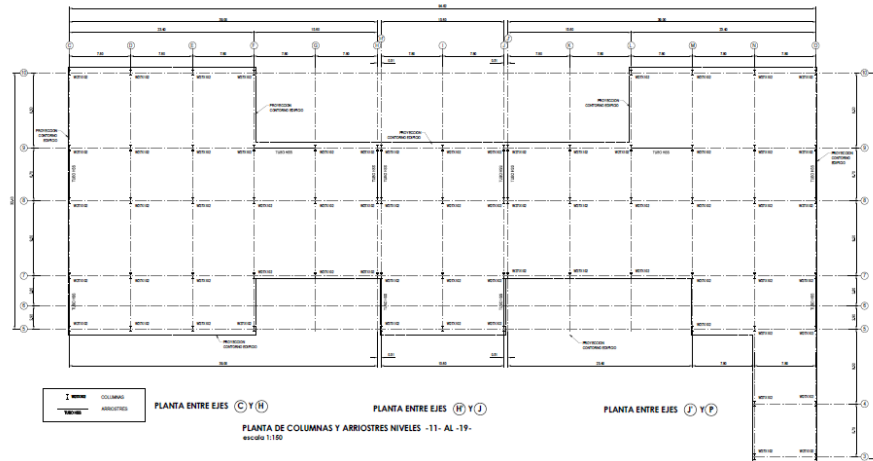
Planta Estructural Columnas, Muros y Arriostres. Nivel 11-19
